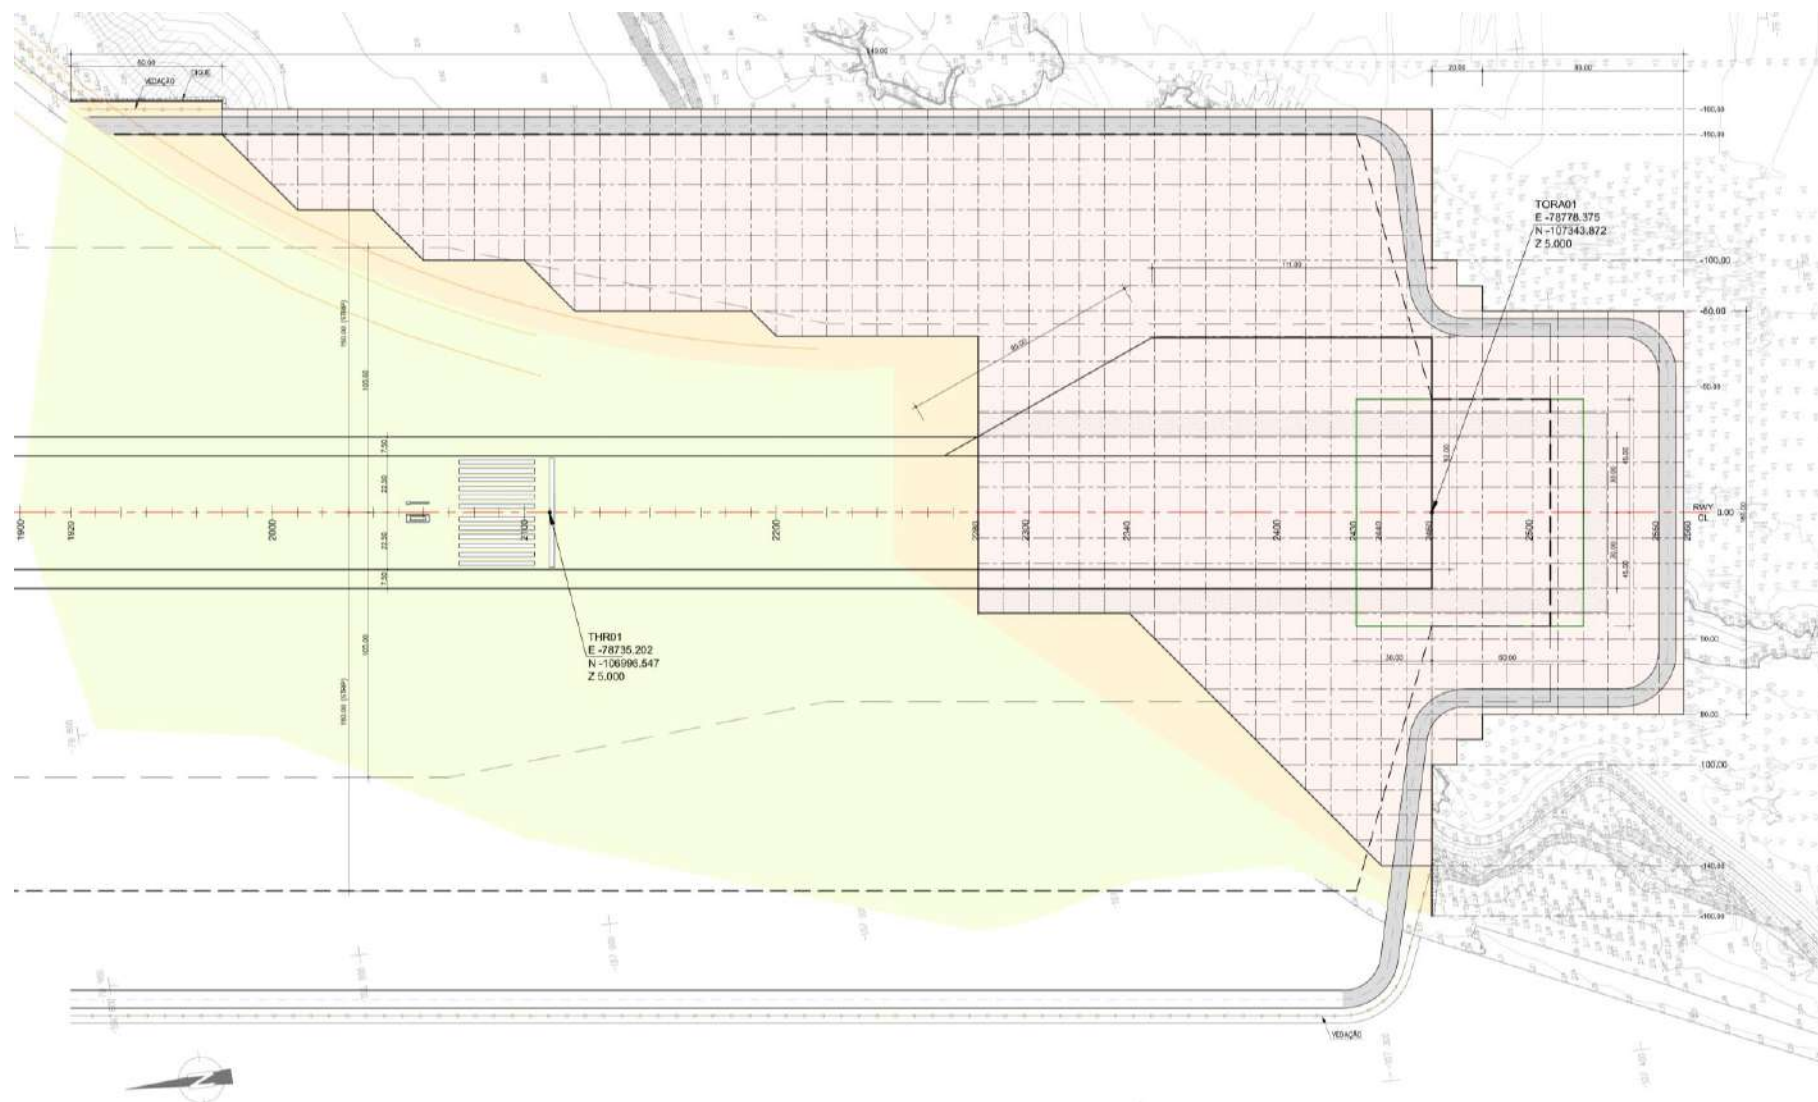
Área de implantação da Solução Alternativa 1 – Estrutura em Betão Armado
